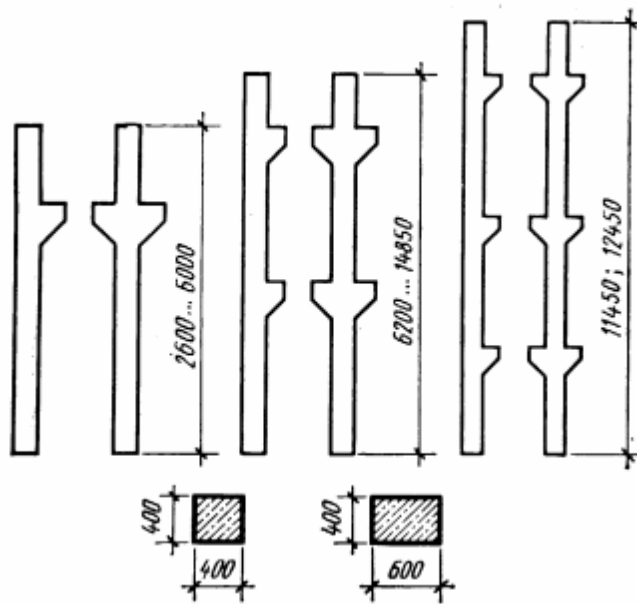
Типи залізобетонних колон багатоповерхових промислових будівель
